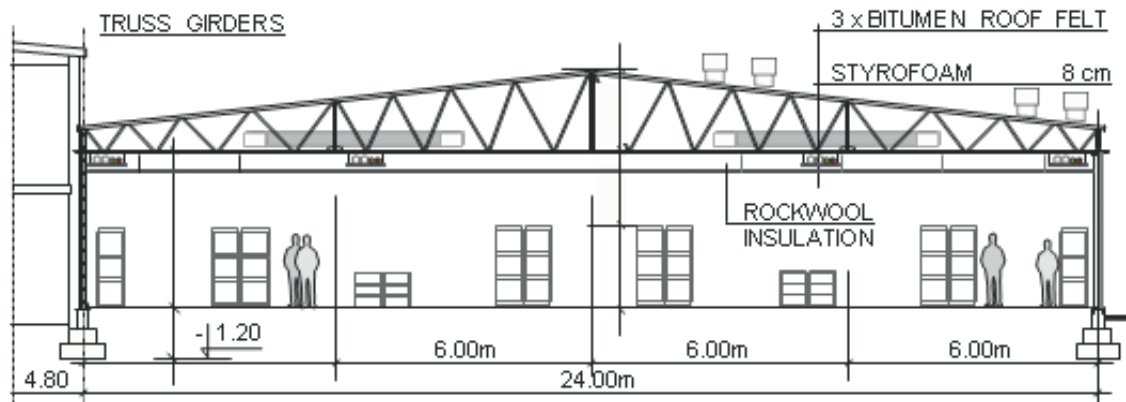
Sección transversal de la instalación, disposición de los elementos estructurales antes del colapso
